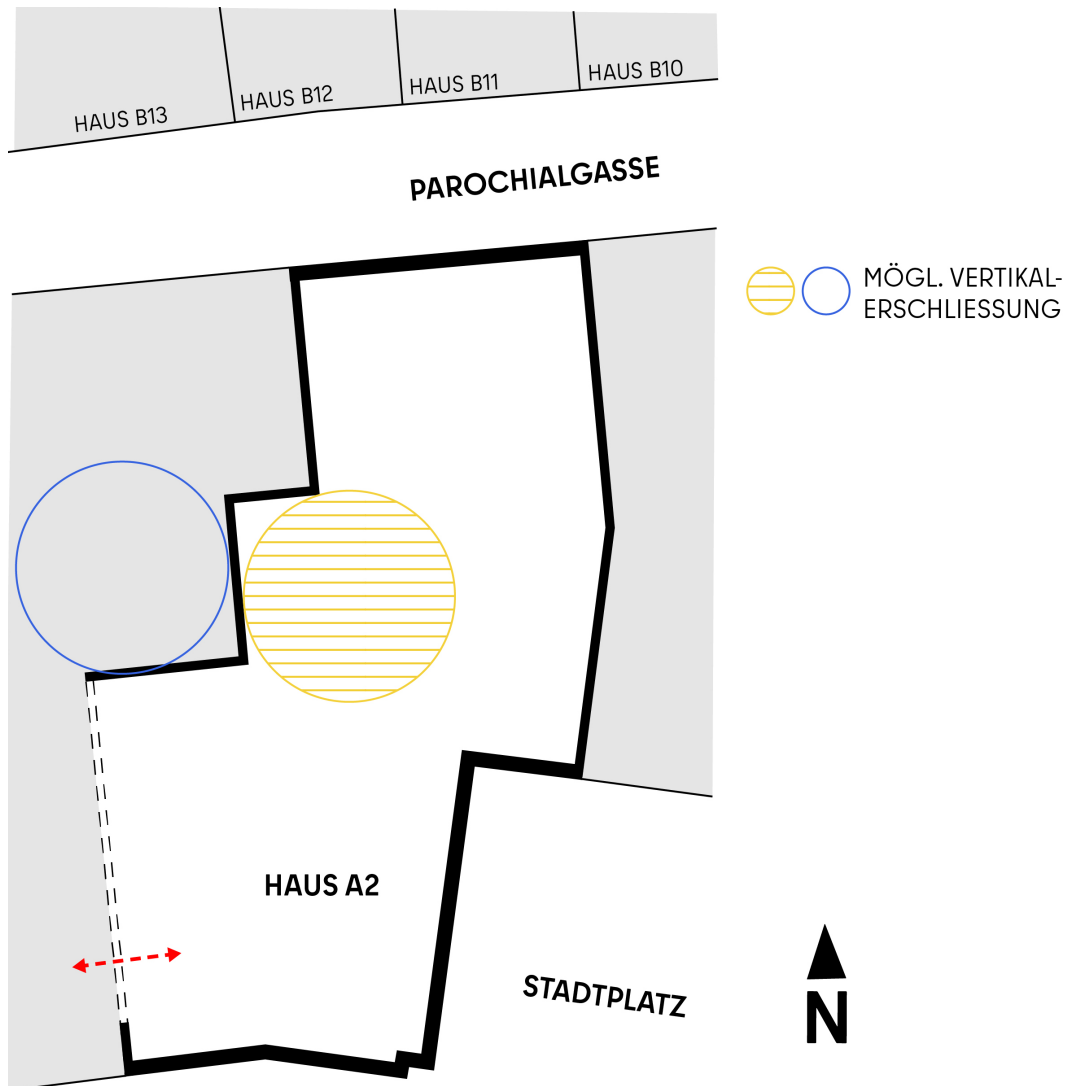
Schematischer Grundriss Untergeschoss
